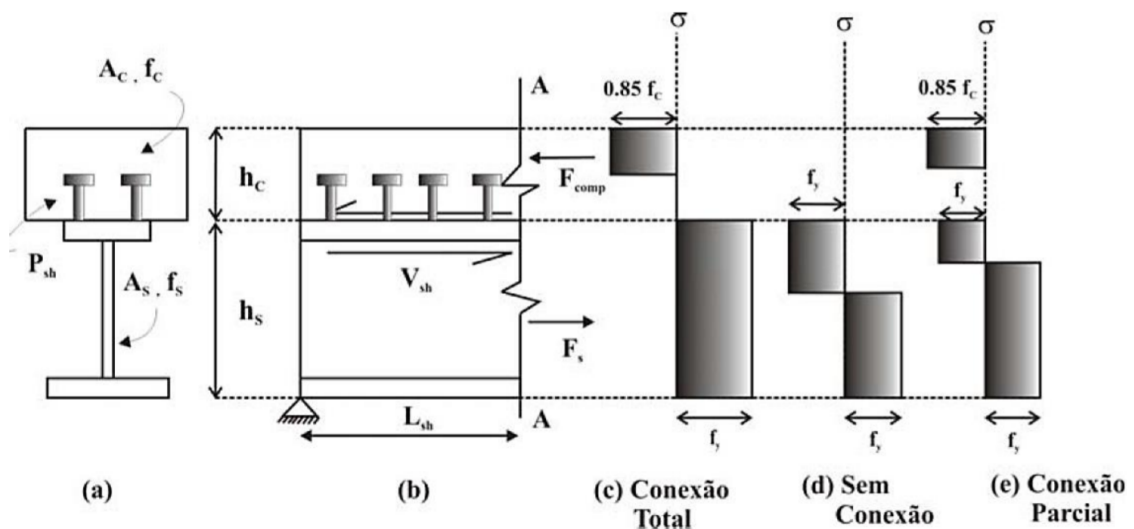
Equilíbrio longitudinal de forças em vigas mistas
